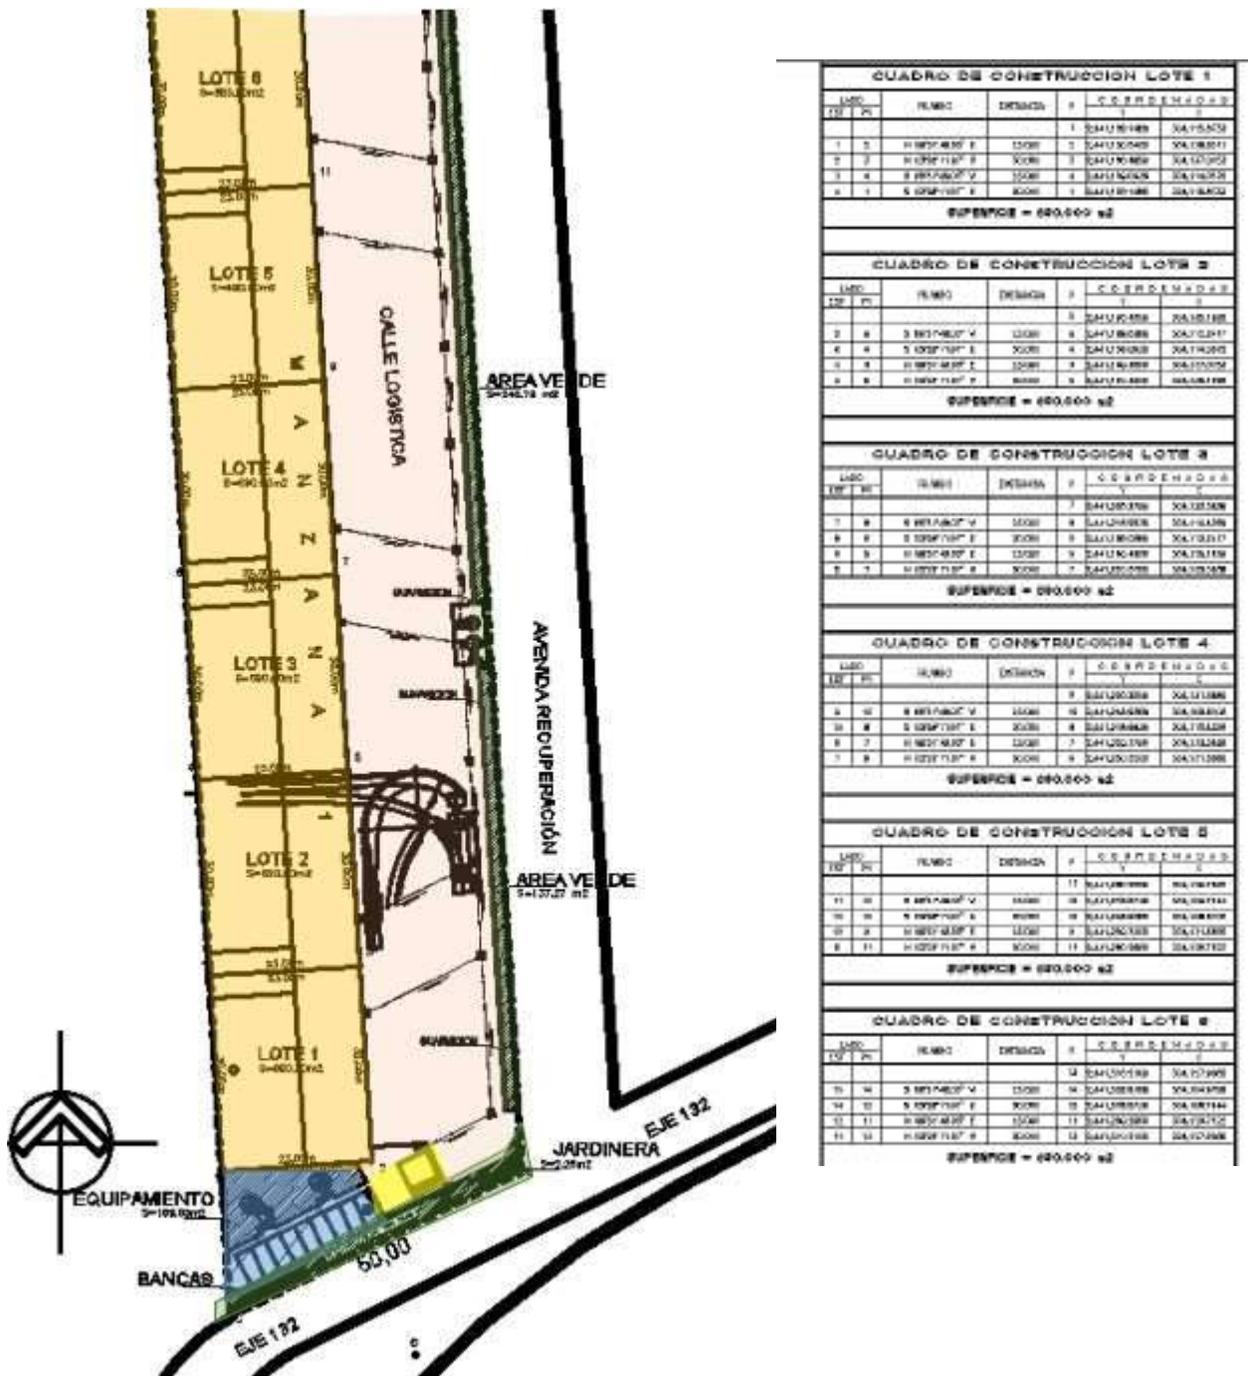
CROQUIS CON DISTRIBUCION DE AREA
